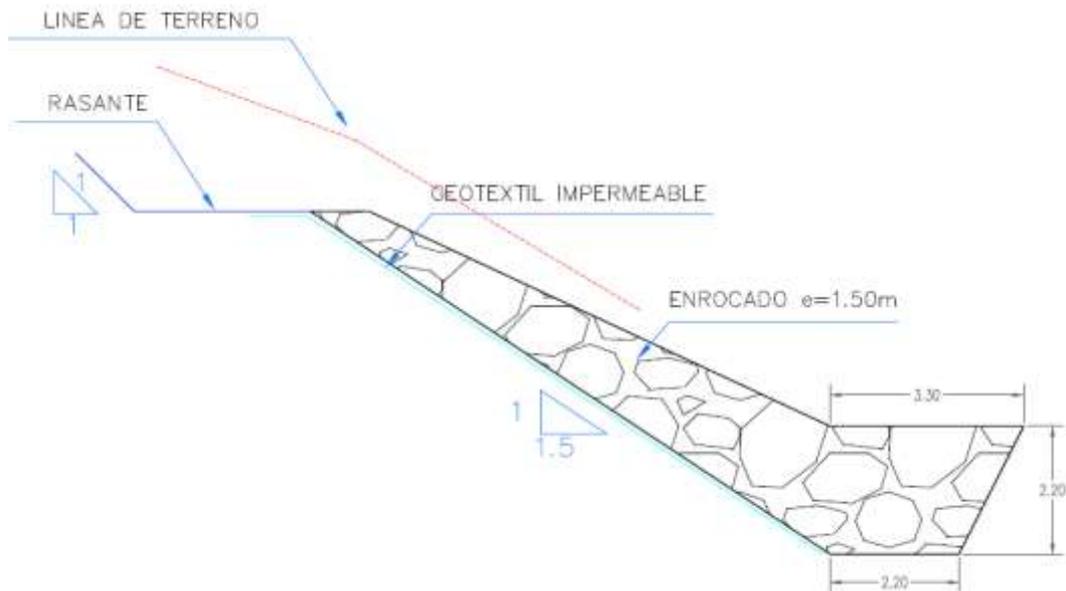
Sección de la defensa ribereña-Ver planos en anexos
